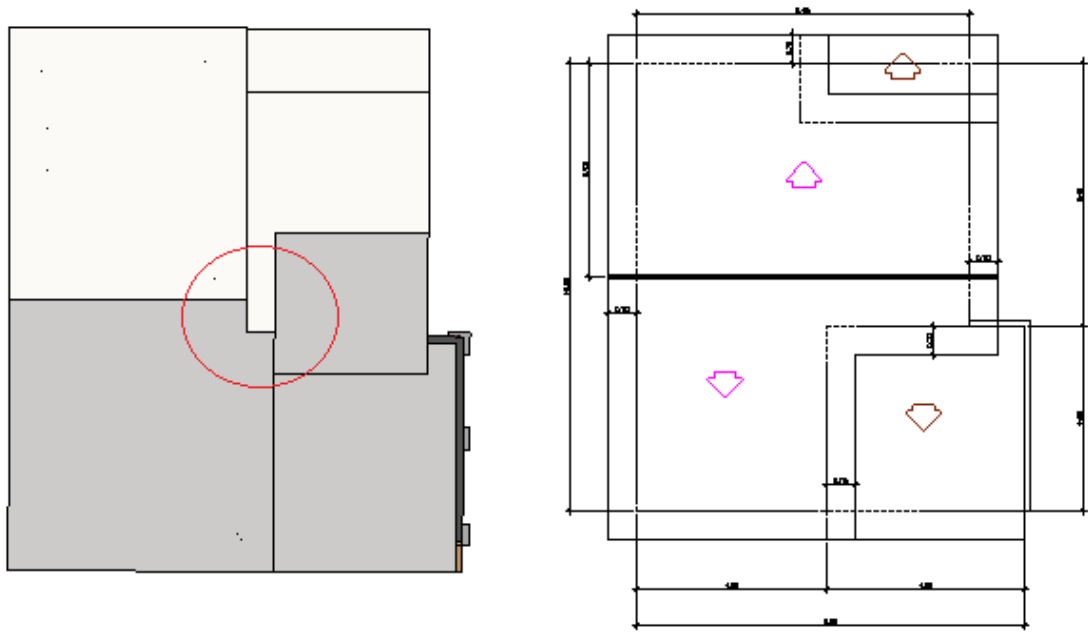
Telhado modelado no Revit x telhado do projeto de AutoCAD
